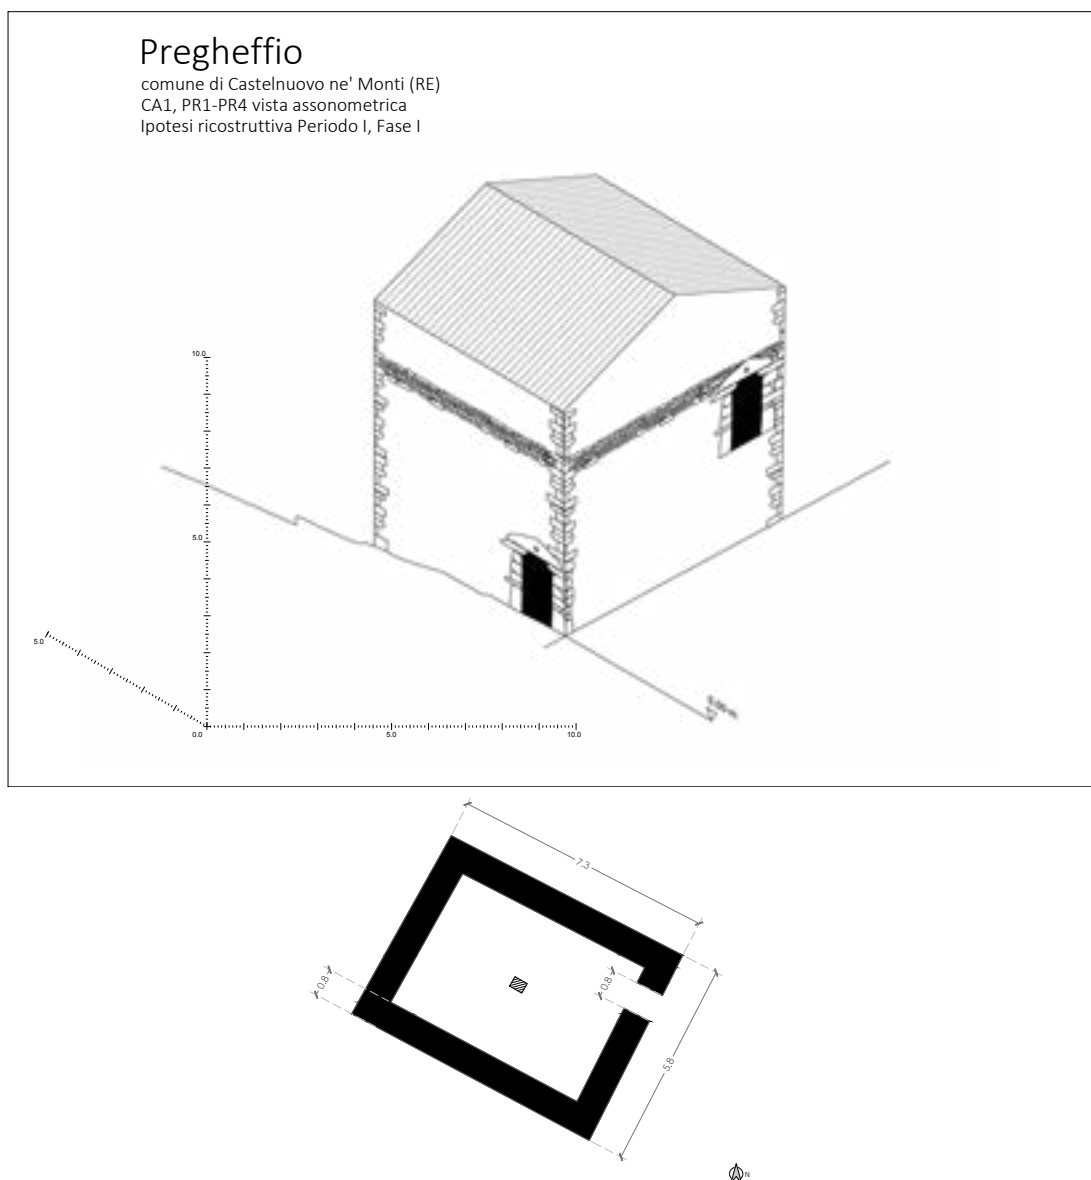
Pregheffio, ricostruzione assonometrica della prima fase e pianta.
